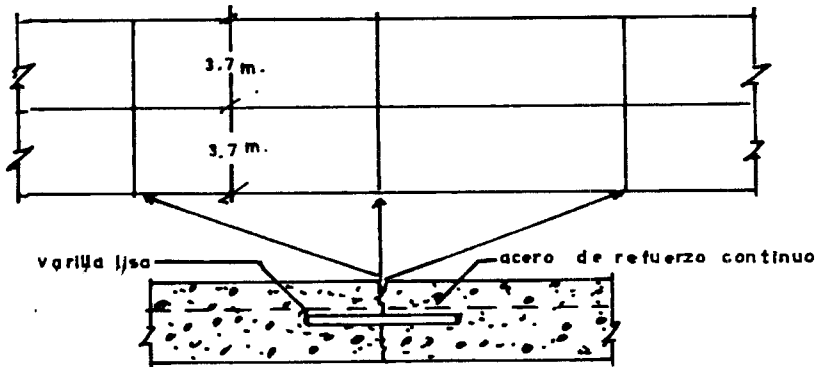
8 Juntas transversales pavimentos con refuerzo continuo
